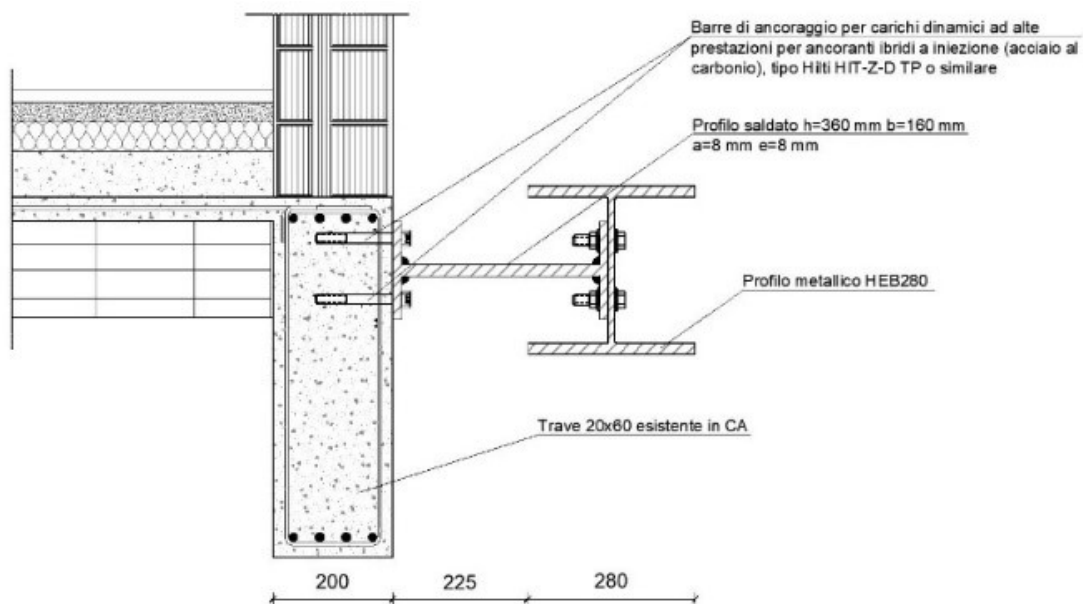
Collegamento dei profili HEB280 alle travi in c.a. sui prospetti in direzione Y.
